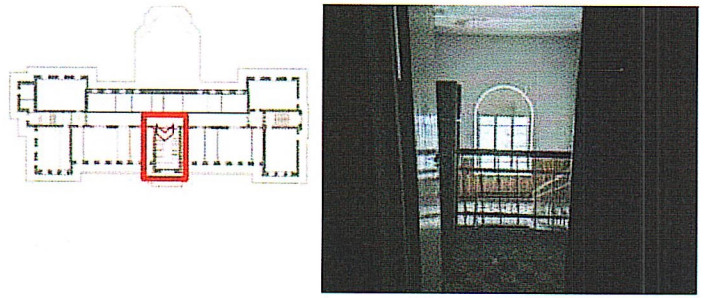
План с обозначением помещения с кирпичной перемычкой арочного оконного проема
